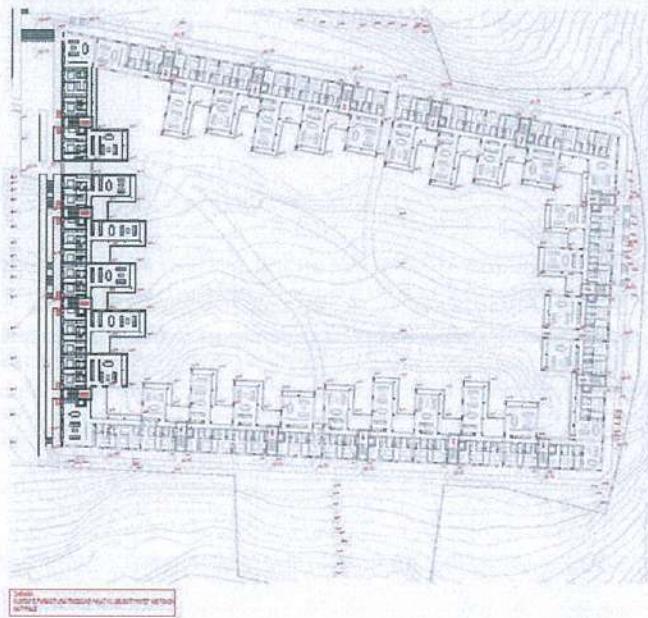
Planimetria e objektit jugor në Kuotën + 205.10
